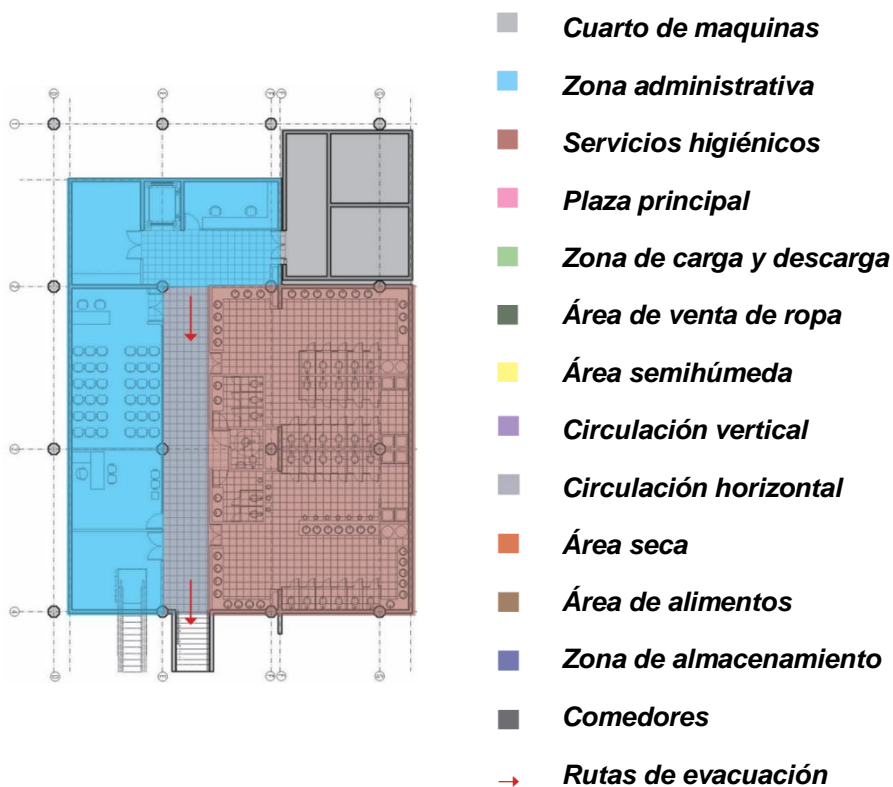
Planta de subsuelo - Mercado Tirso de Molina.
